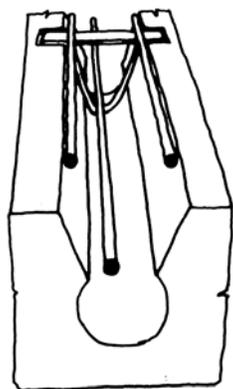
Sistema de hormigón armado y ahuecado de las vigas.
